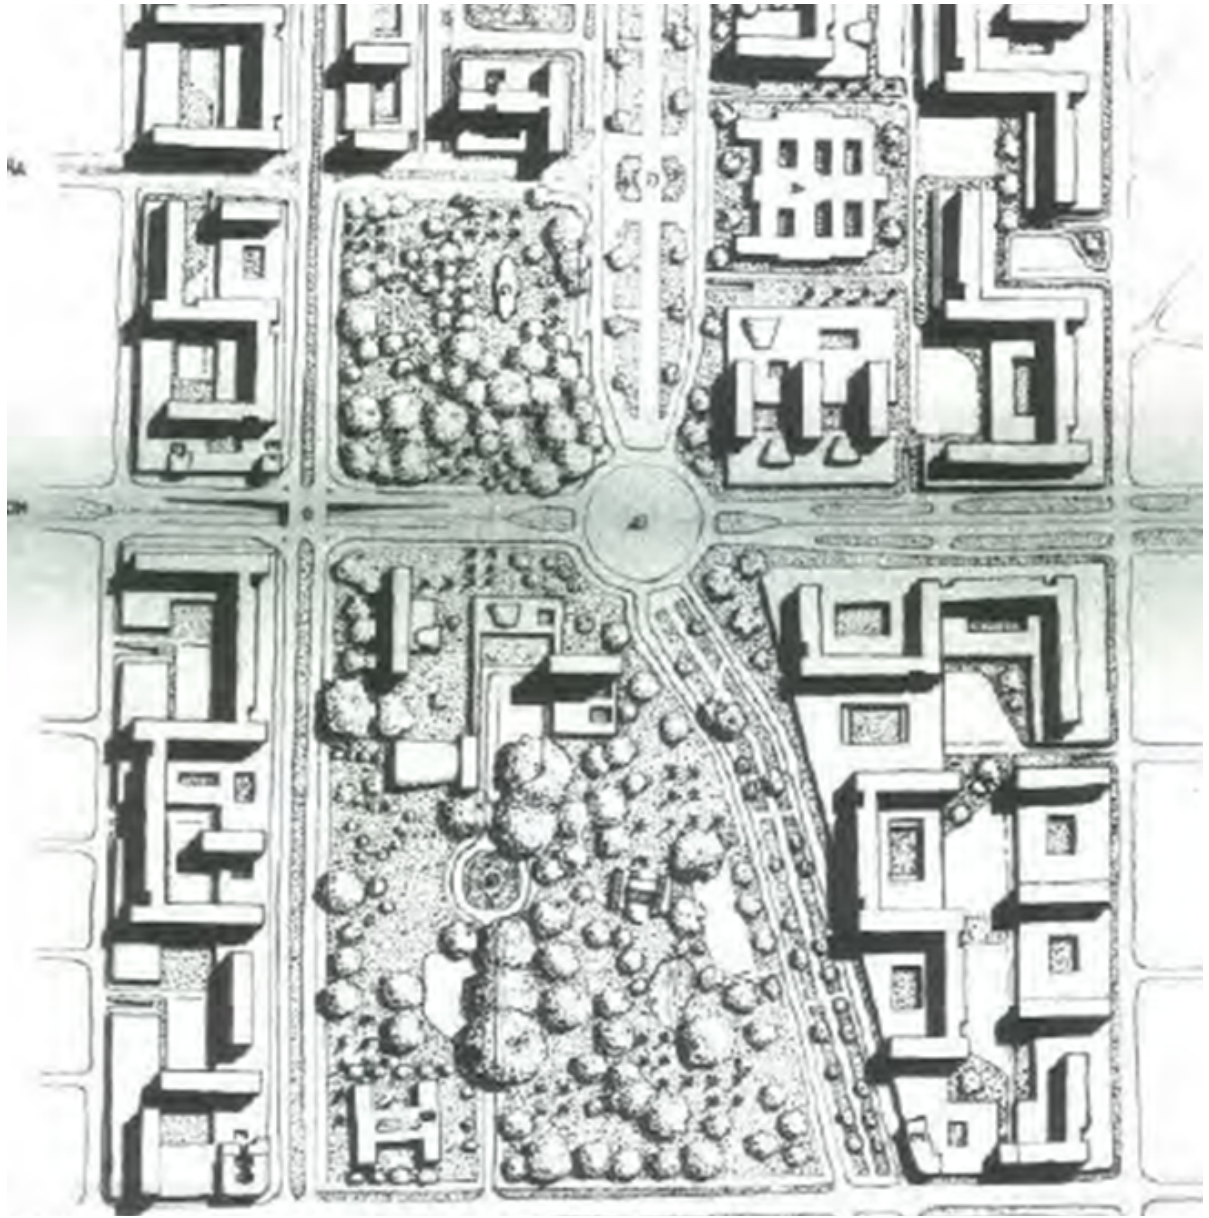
Centro Cívico de Lima. Autor: Josep Lluís Sert. Versión a mano alzada. 1949. Fuente: "Lima. Plan Piloto, 1949".
